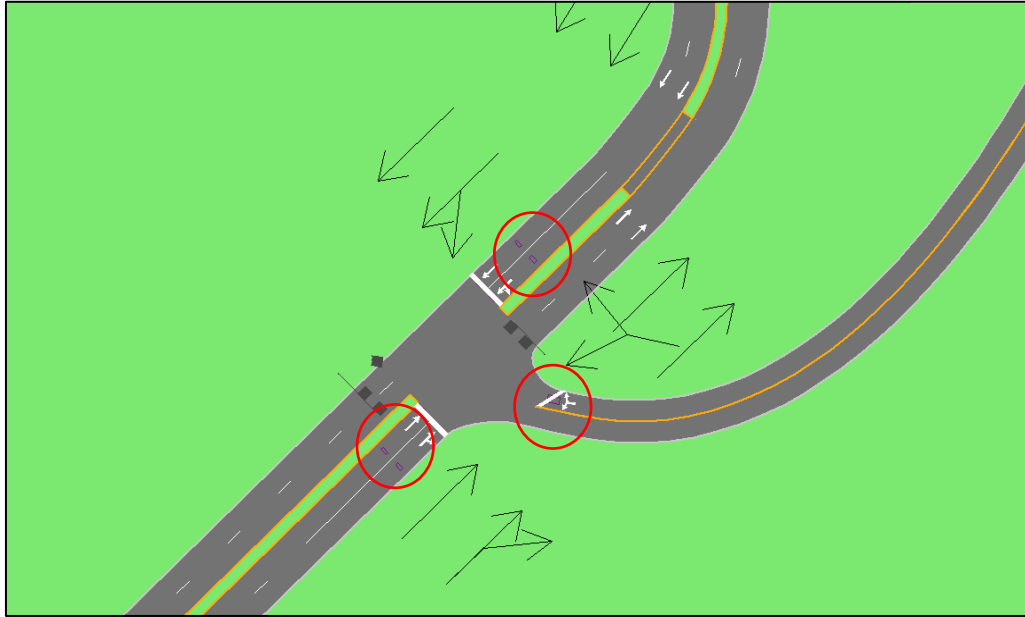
Vista en planta de las bermas centrales agregadas en la propuesta.
